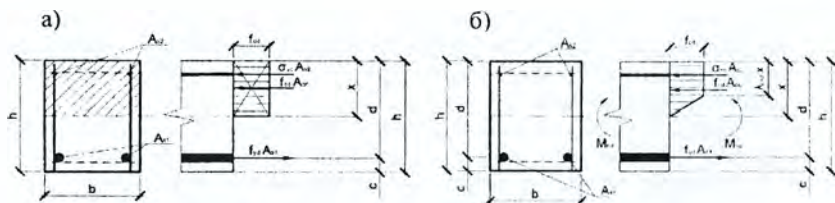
К расчету нормальных сечений железобетонных изгибаемых элементов:
